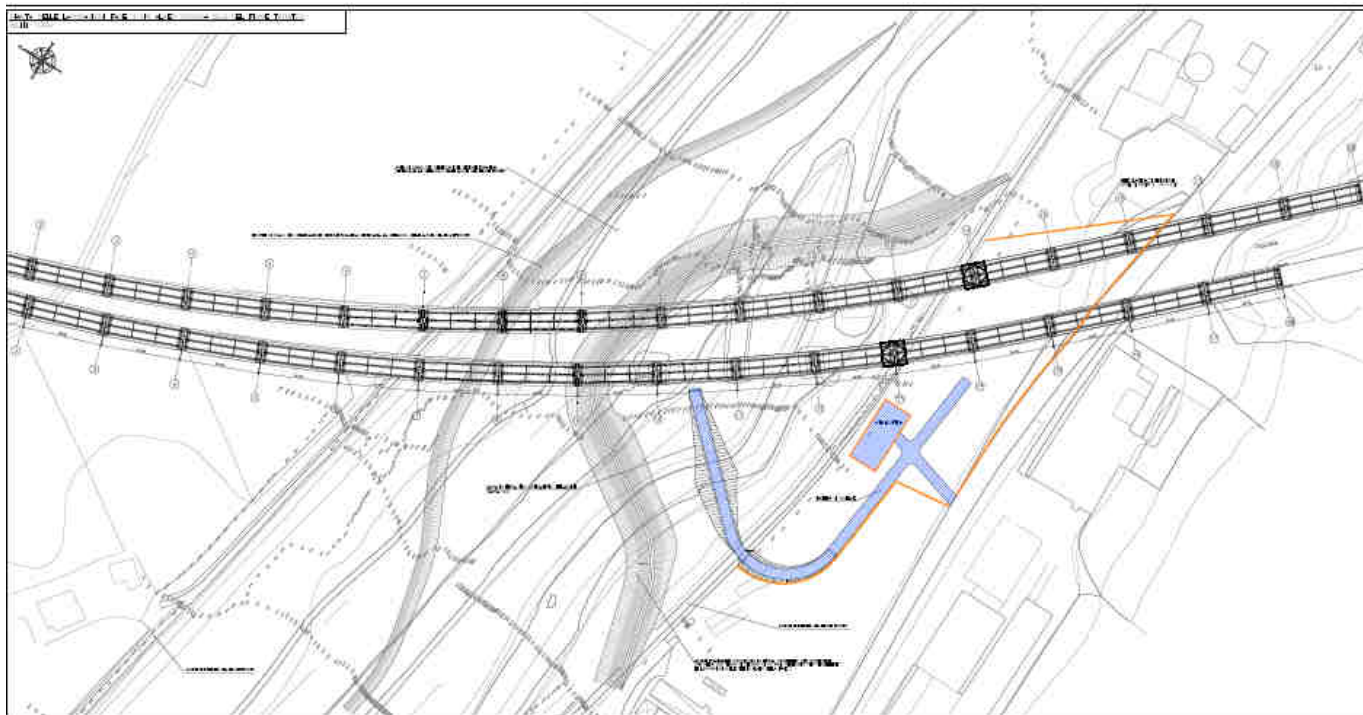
aree di cantiere e accessibilità per il risanamento delle pile da 11 a 13
